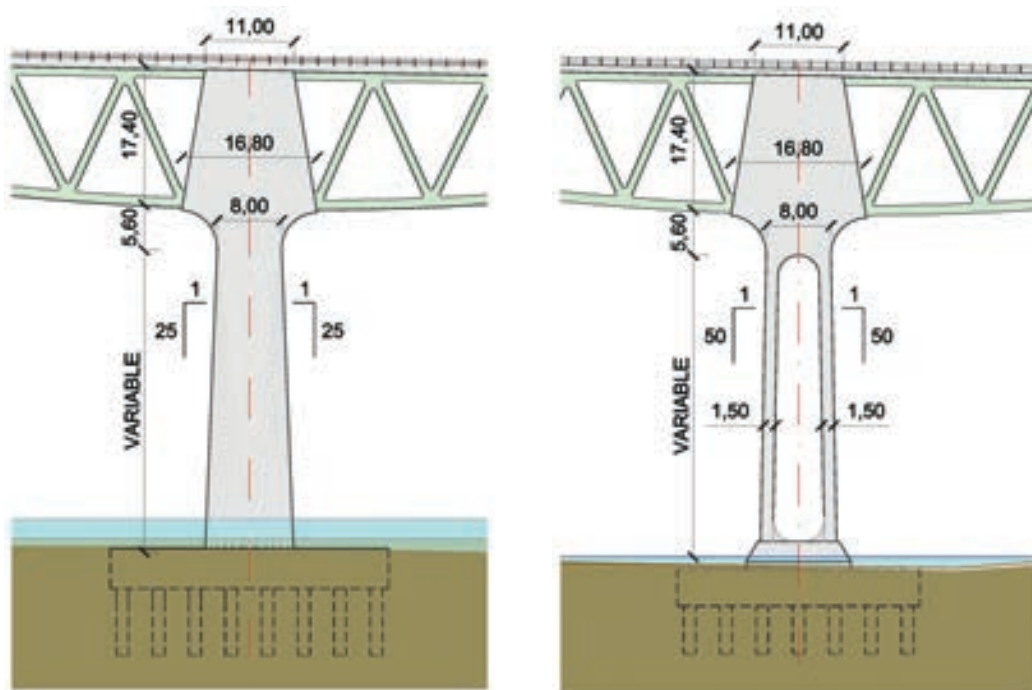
y 28b. Vista de las pilas centrales (P-6 y P-7) y laterales (P-5 y P-8)
